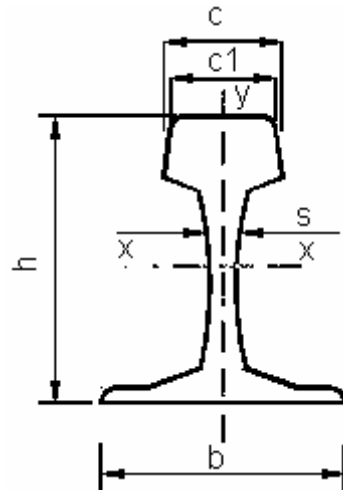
Trilho ferroviário, tipo Vignole. (METÁLICA, 2006)
